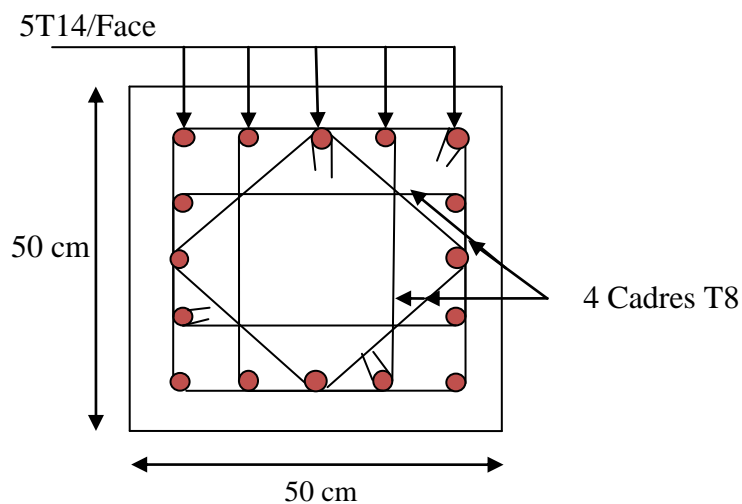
Schéma de ferrailage des poteaux de 5^{ème} , 6^{ème} étage .
